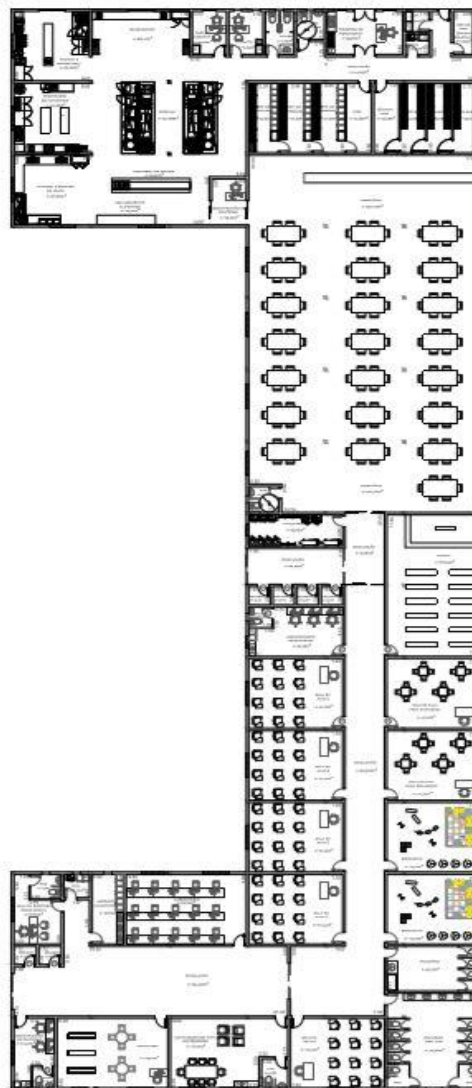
Planta Humanizada – Fonte: Acervo Próprio
